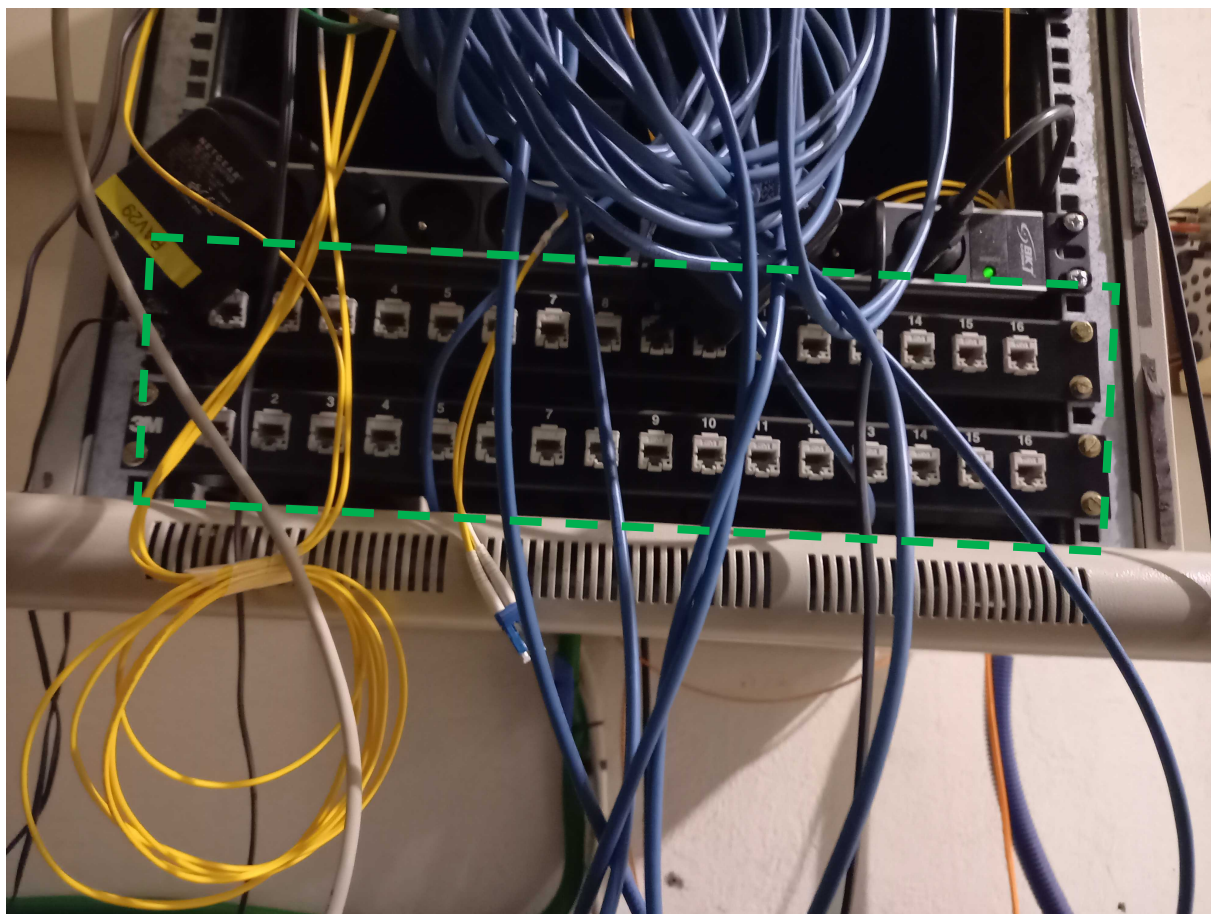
Photo de la baie informatique existante. Un panneau de brassage devra être installé à la place des anciens panneaux de brassage de la téléphonie (encadrés en pointillés verts)
